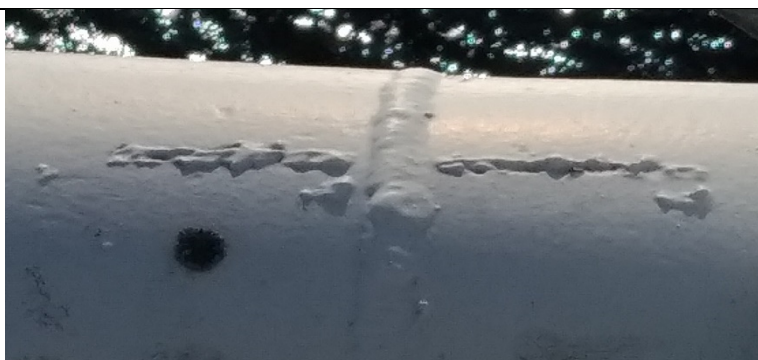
Ložiska konstrukce K02 na pilíři P1
